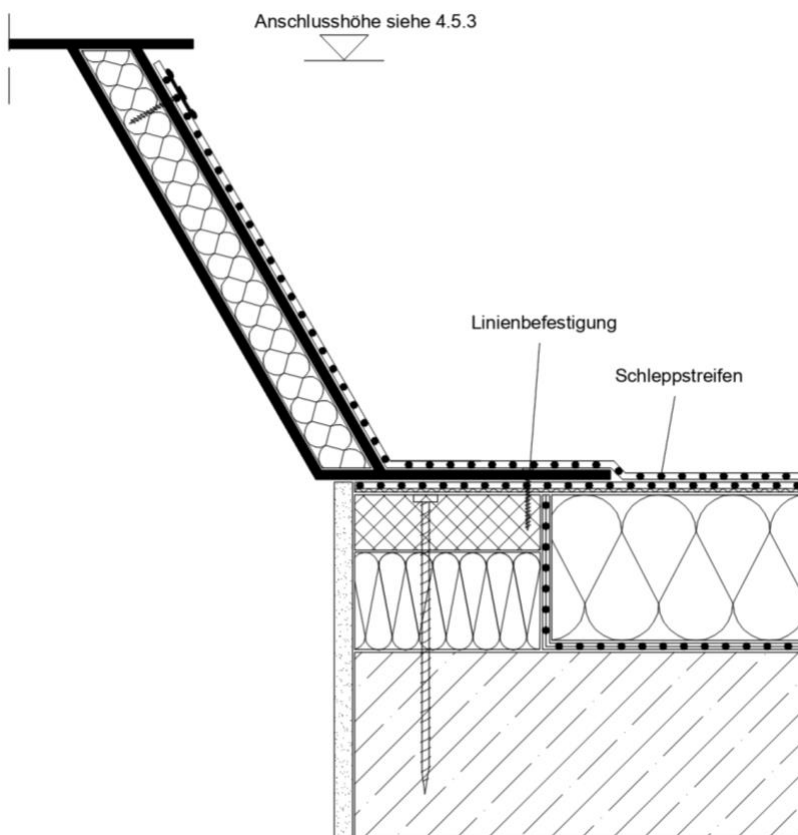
Lichtbandanschluss mit Stahlzarge – Ausführung mit Bitumenbahnen
